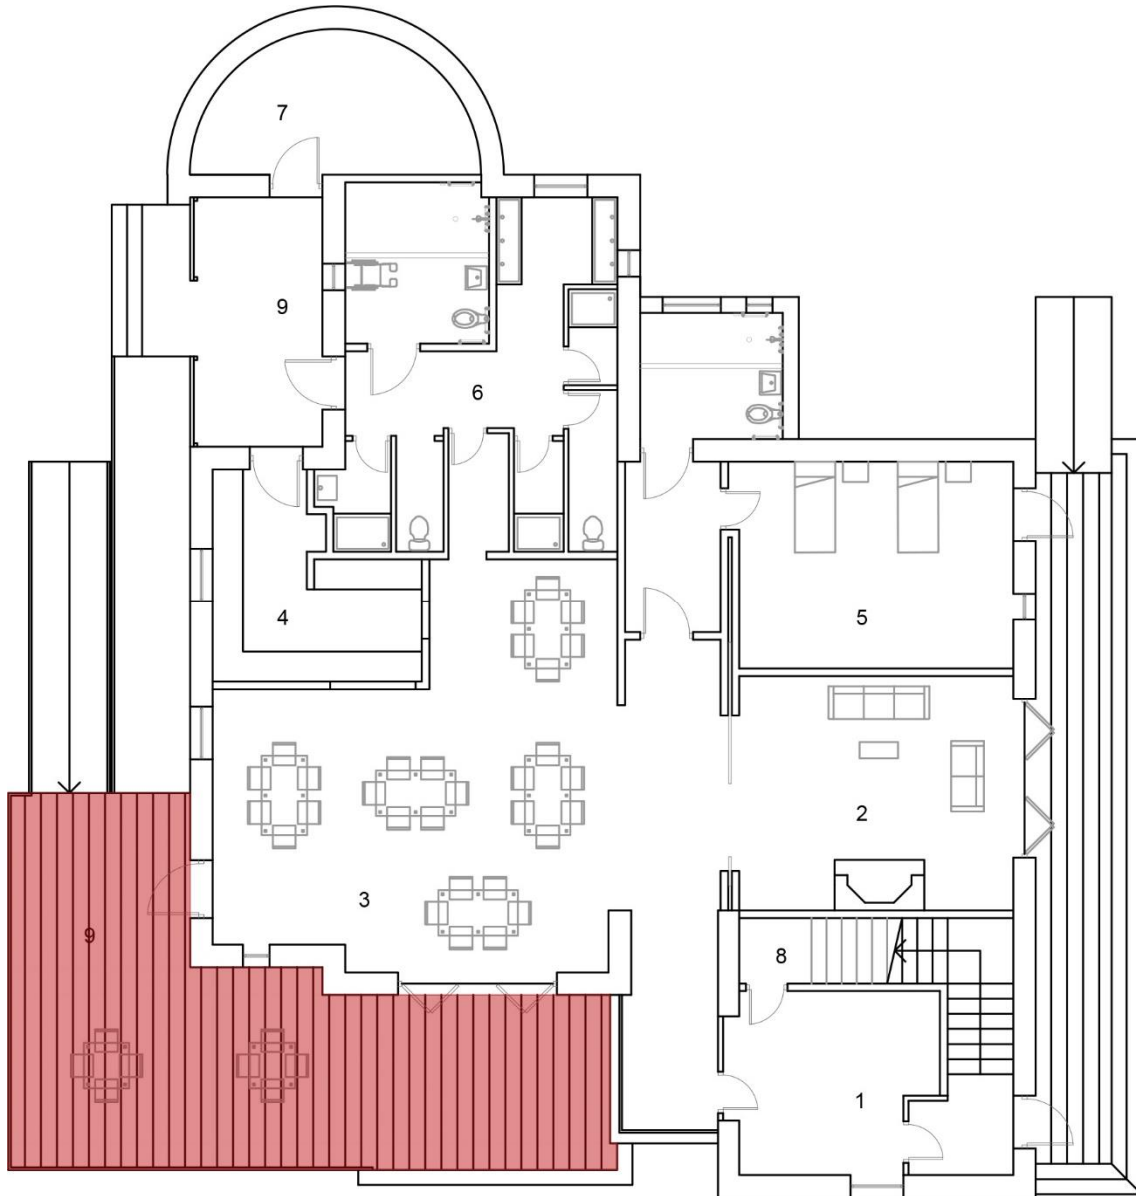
Plano a escala 1:500. Zona roja: terraza cubierta.
